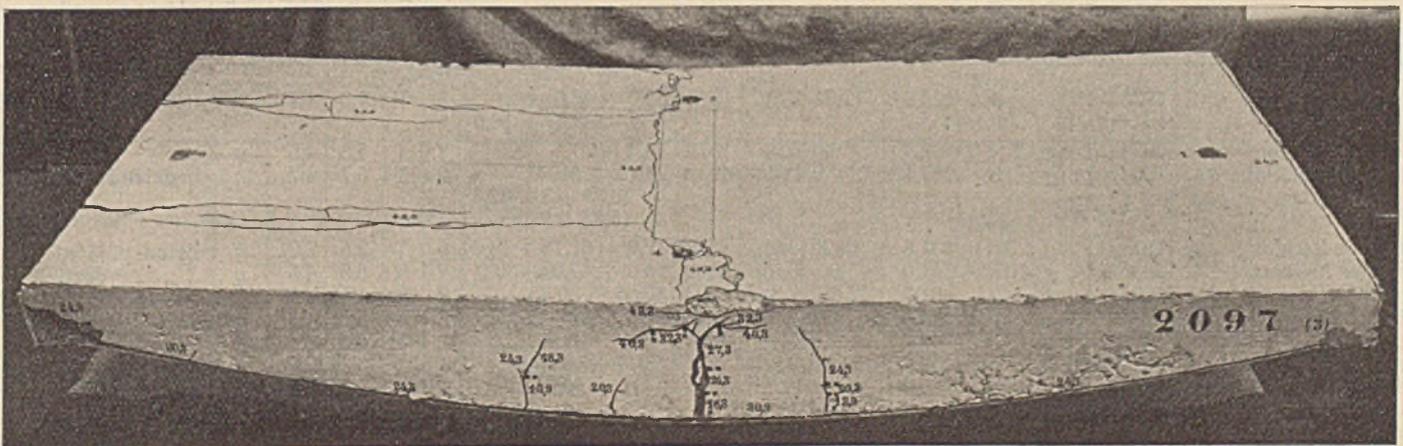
Versuchskörper III. Die linke Hälfte der Betonfüllung hat sich losgelöst und schiebt sich über das Auflager ab.
